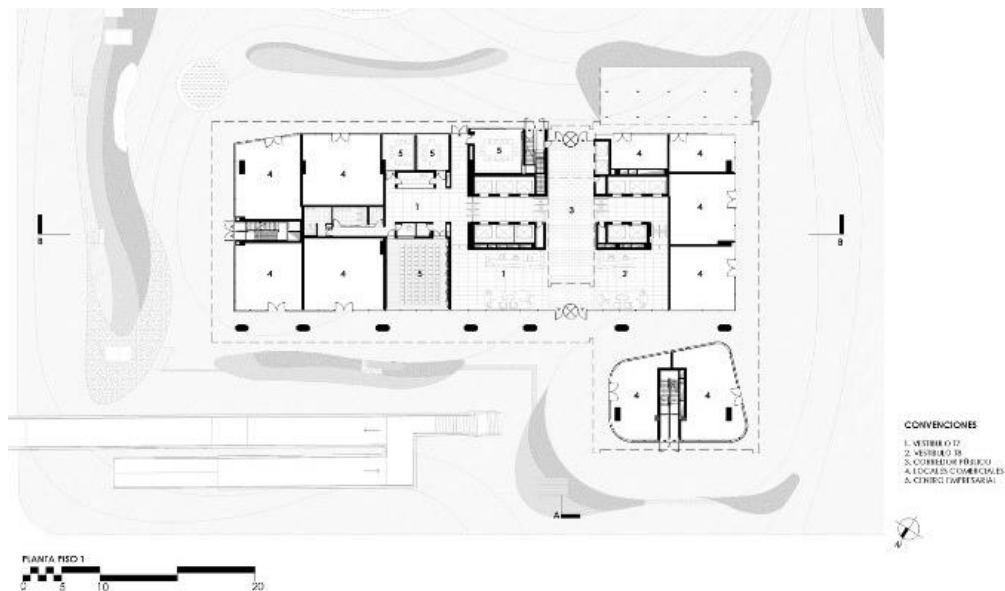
Primera planta del Centro empresarial T7 / T8 – sarmiento Angulo
